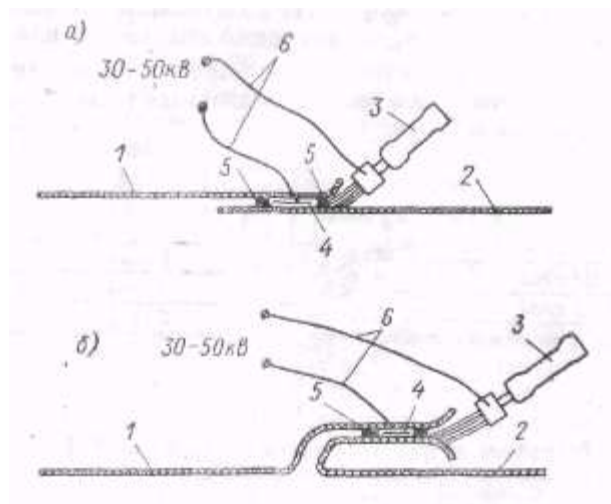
Схема проверки водонепроницаемости сварных швов
